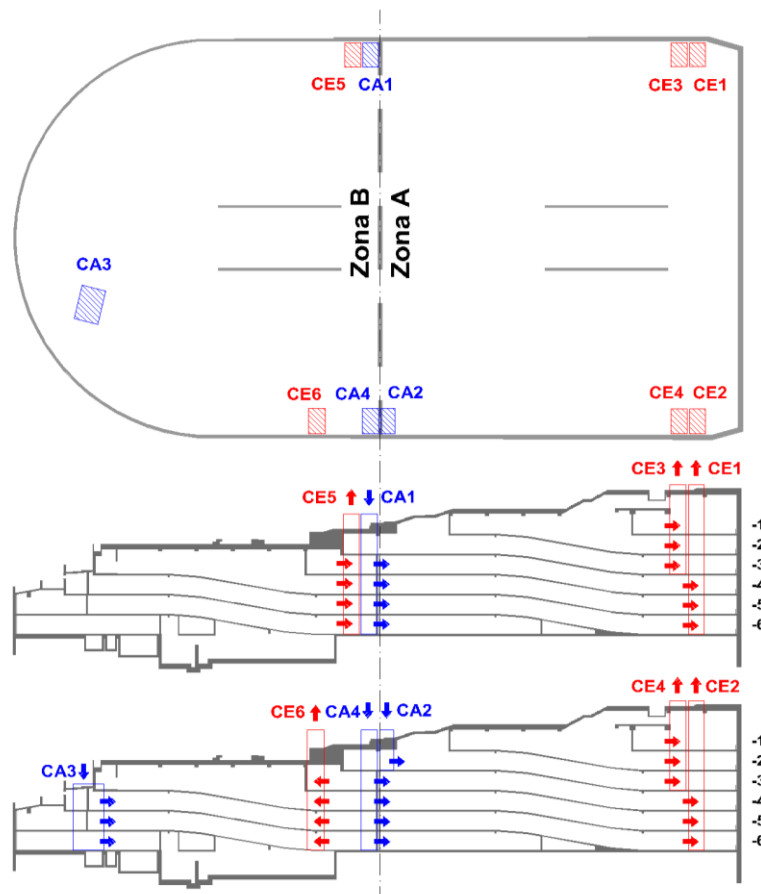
Planta e cortes esquemáticos de condutas de admissão natural e de extração mecânica
